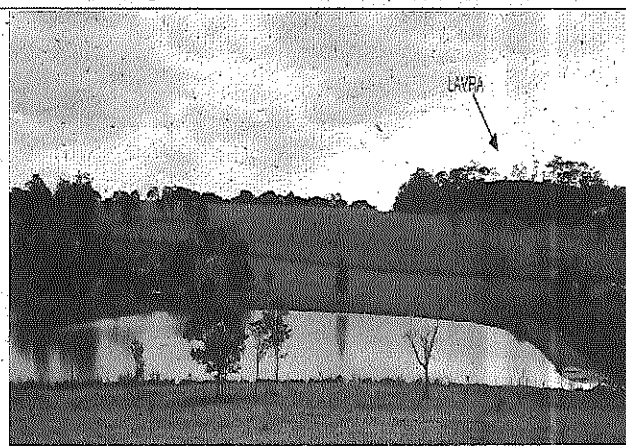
Local de implantação das estruturas diversas e barramento onde será feita a captação de água.
